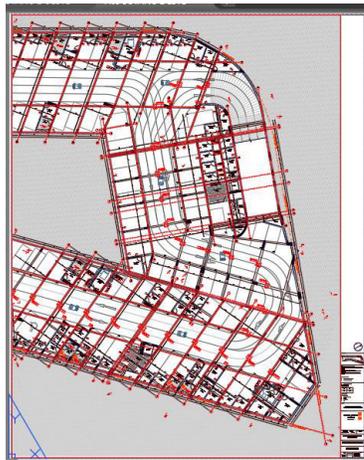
Plano Arquitectura Segundo Sótano Este del Proyecto Ocean Reef
